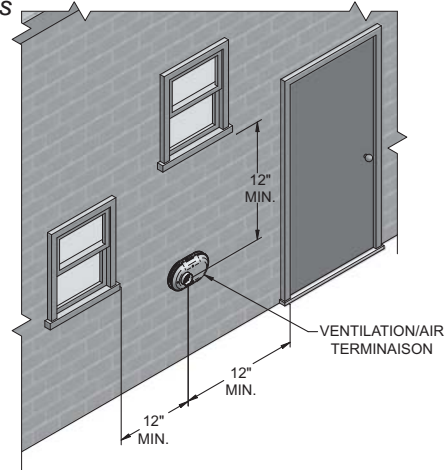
B Espace alternatif par rapport aux entrées d'air gravitaires avec raccords fournis sur place
